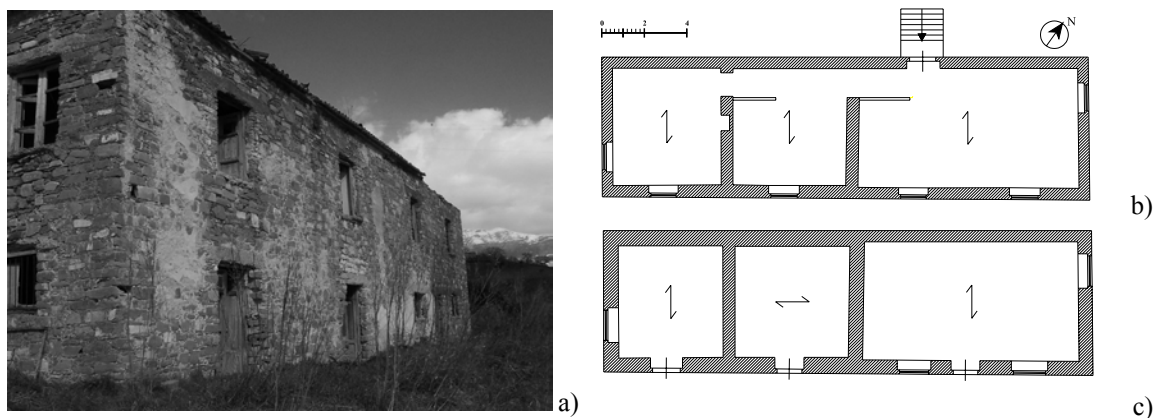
Casale D4 della Valle dell'Alento: a) Vista laterale; b) Pianta primo piano; c) Pianta piano terra.
